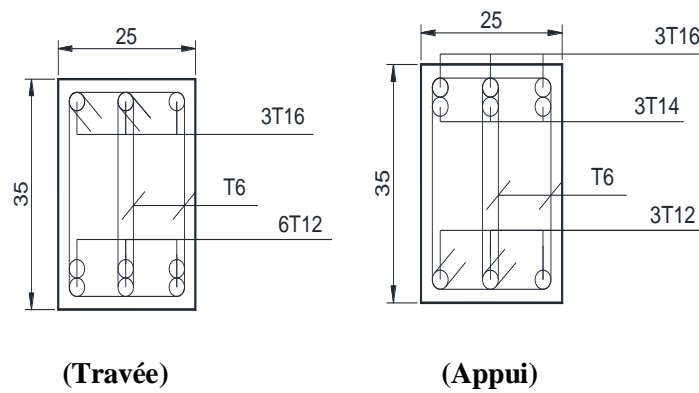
Ferrailage d'une poutre principale 25x35cm (plan fortement irrégulier)
